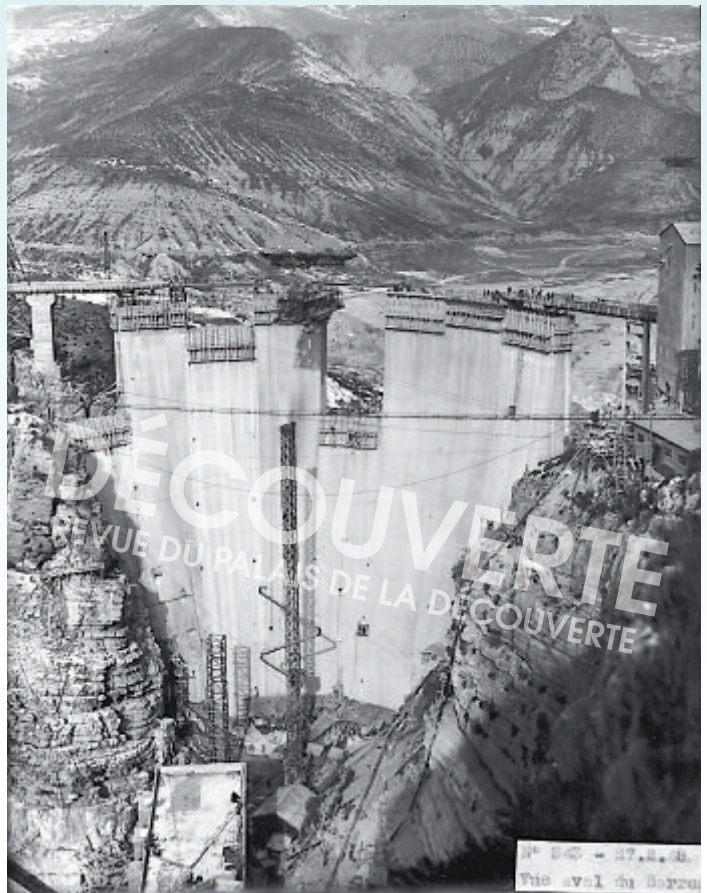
Le barrage en construction en 1948 vu de l'amont. Au premier plan, on voit le pont qui enjambait le Verdon. © EDF.
